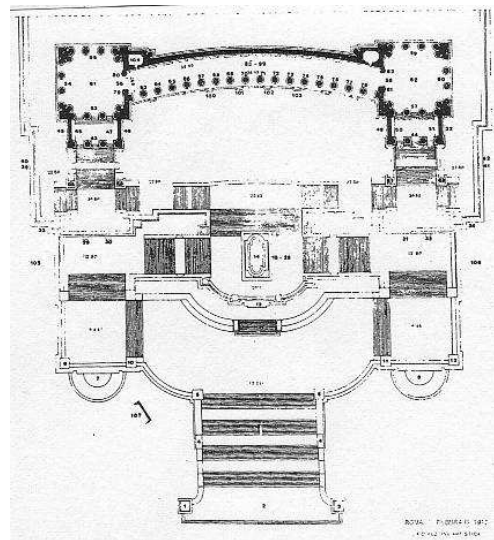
Vittoriano, Grundrissplan.
